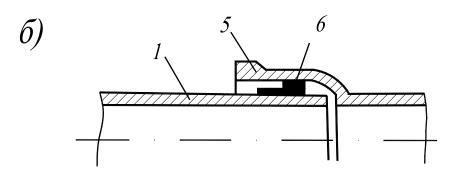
Соединение асбестоцементных и чугунных безнапорных труб: a — стык асбестоцементных безнапорных труб с гладкими концами; δ — стык безнапорных чугунных раструбных труб;
